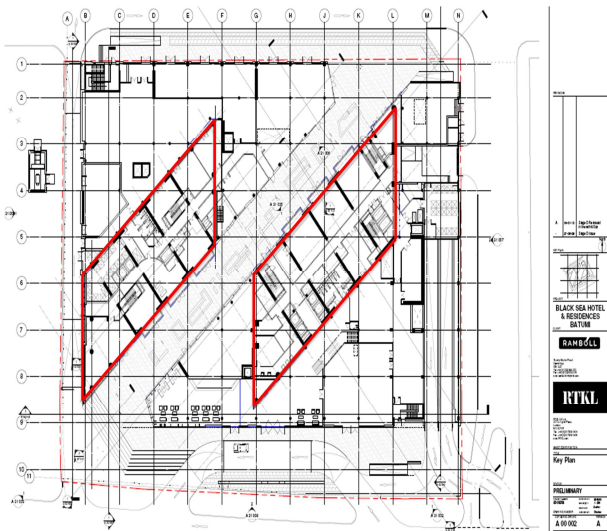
Красными линиями отмечены сейсмические горизонтальные разделяющие швы на плане и в конструкциях по первому варианту проекта / The red lines indicate the seismic horizontal dividing joints on the plane according to the structure on the first draft
